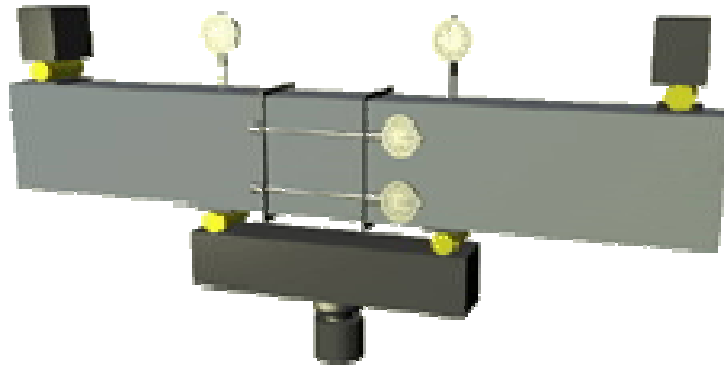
Модель залізобетонної балки на випробувальному стенді
